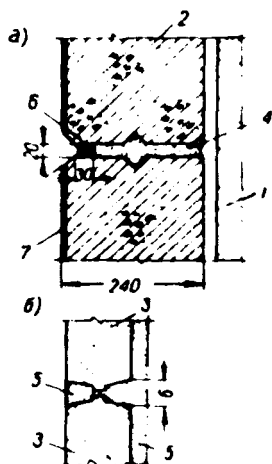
Панели длиной 6 м из керамзитобетона с облицовкой из стеклянных плиток
